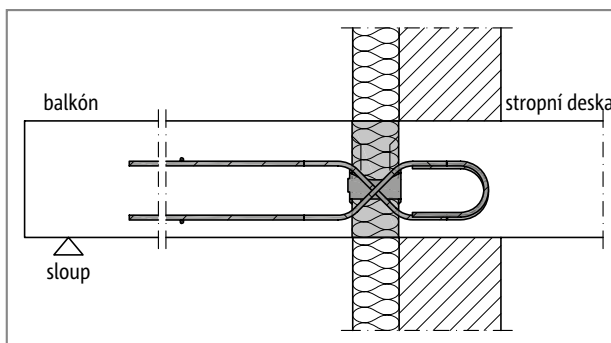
Schöck Isokorb® typ QP20S: Podepřený balkón, nezateplené zdivo
